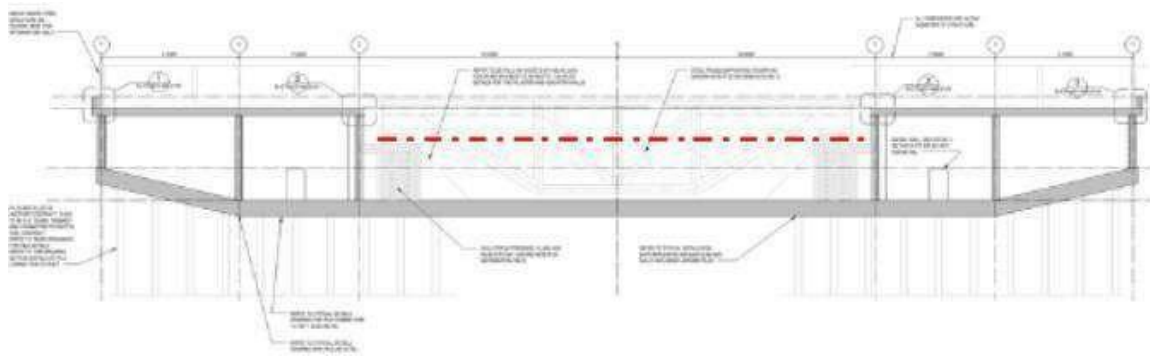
Sección transversal del cimiento de la TCTA. Incluye vigas de transferencia radial, ubicación de soplano de aislamiento (línea roja discontinua)
